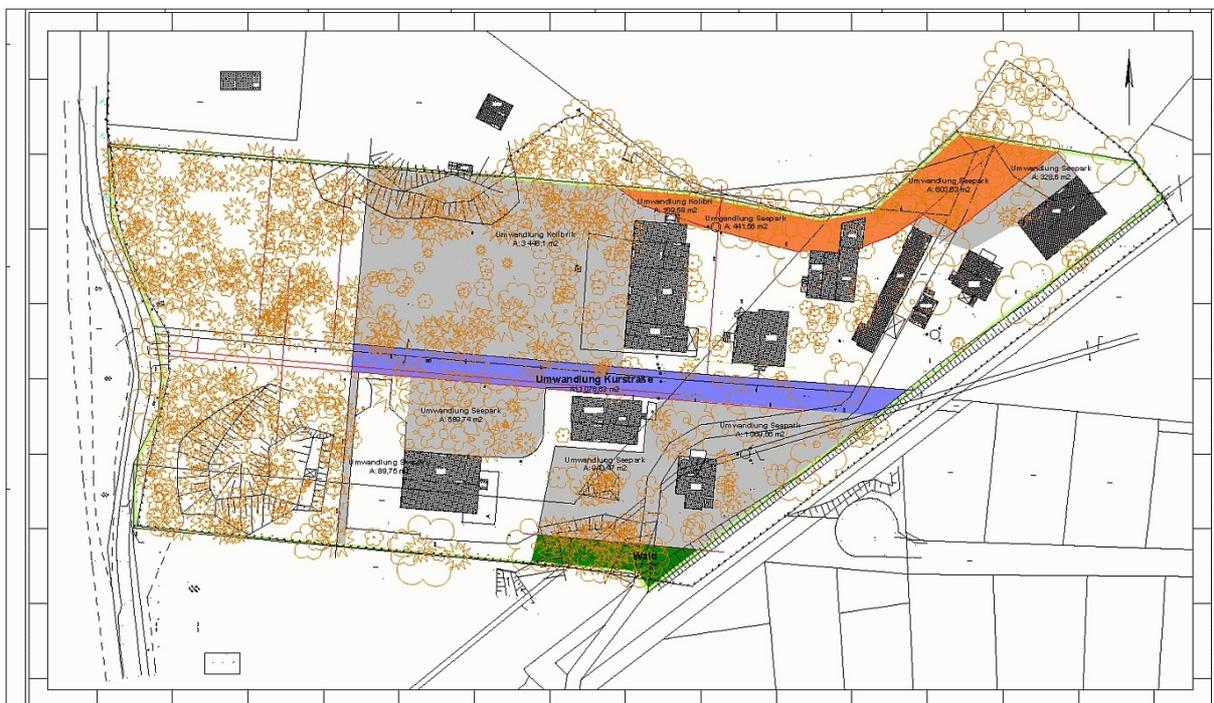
zur Waldumwandlung in Aussicht gestellte Flächen (farblich unterlegt), Quelle: Stasik, K.Starke
